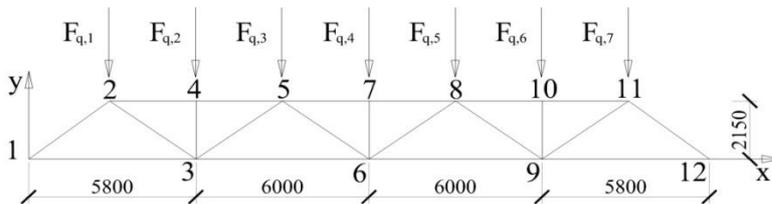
Розрахункова схема для визначення зусиль в стержнях ферми від дії снігового навантаження.
